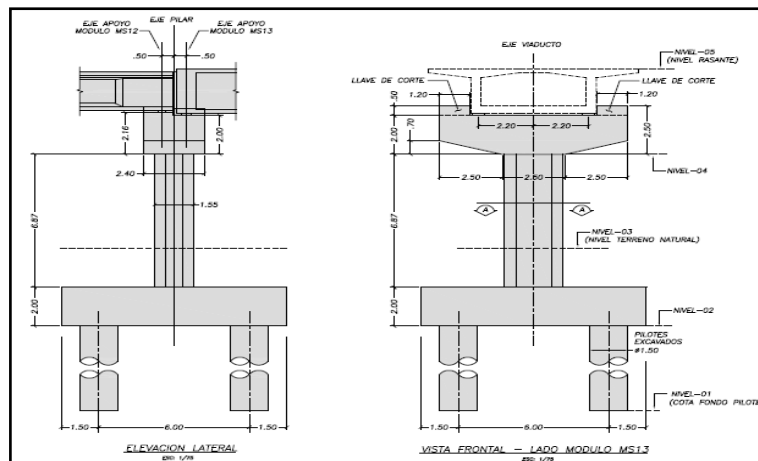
Elevación Pilar S48 (Similar al Pilar S52)
